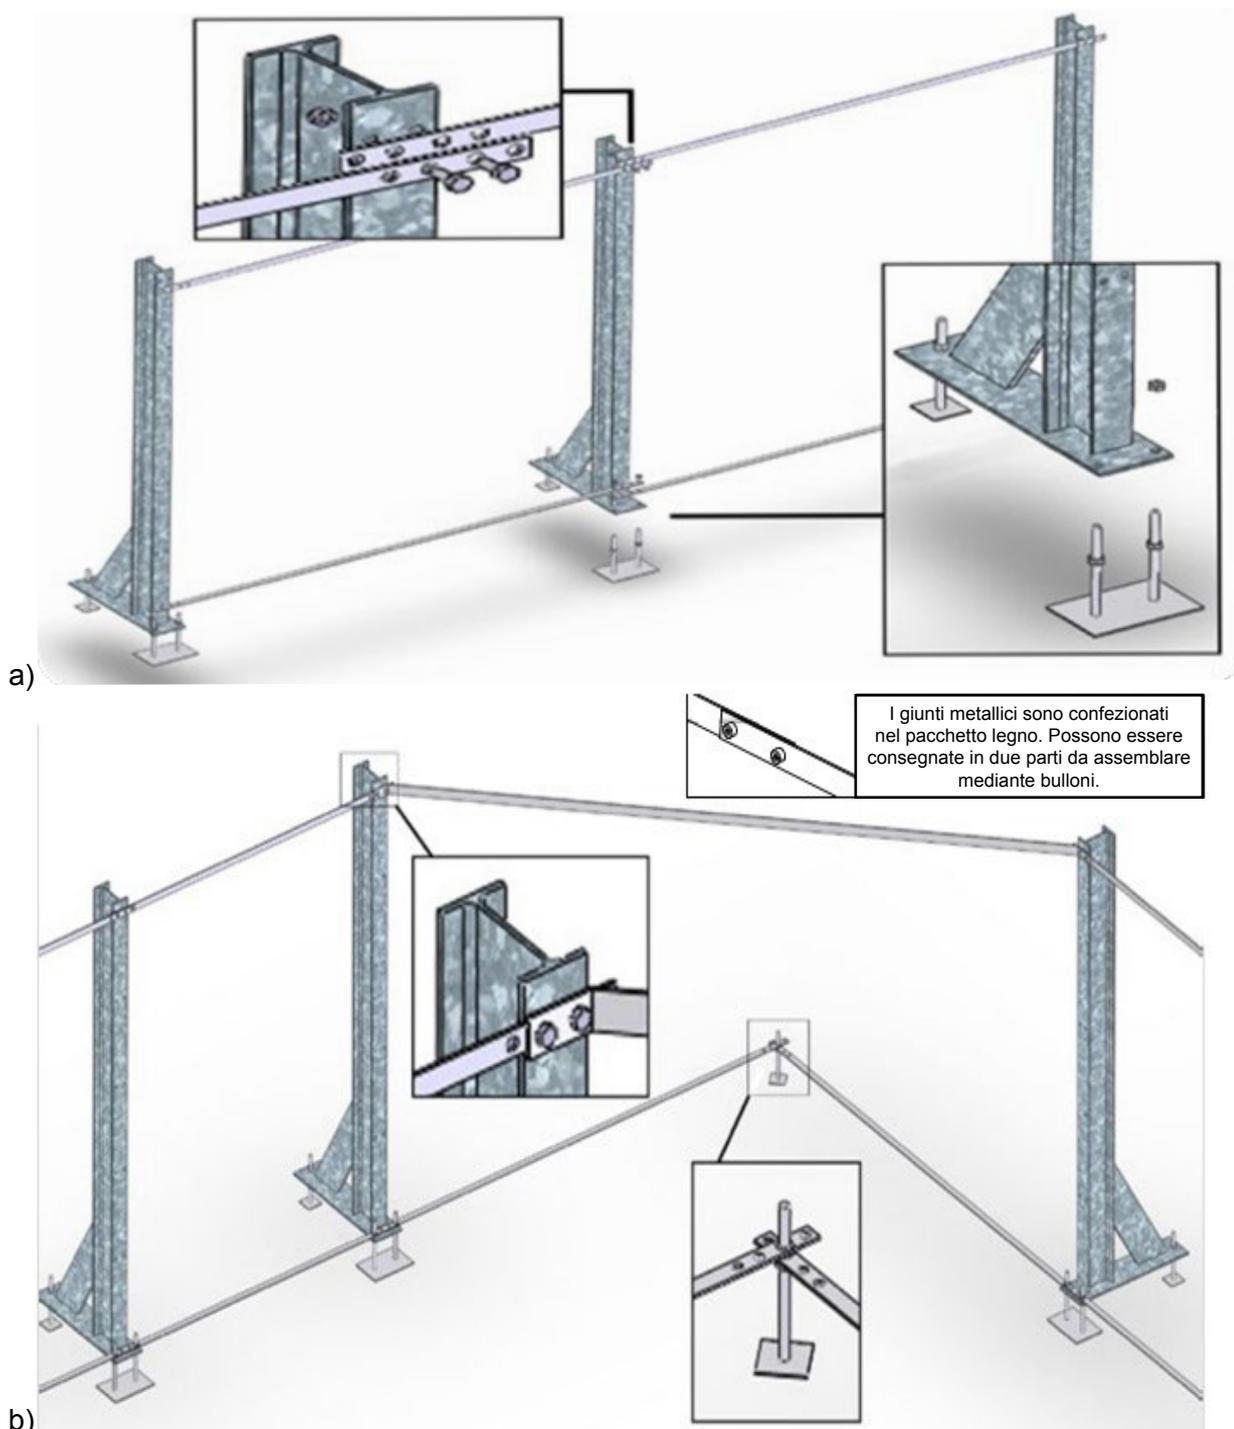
a e b – Assemblaggio dei giunti sui pali di fondazione
